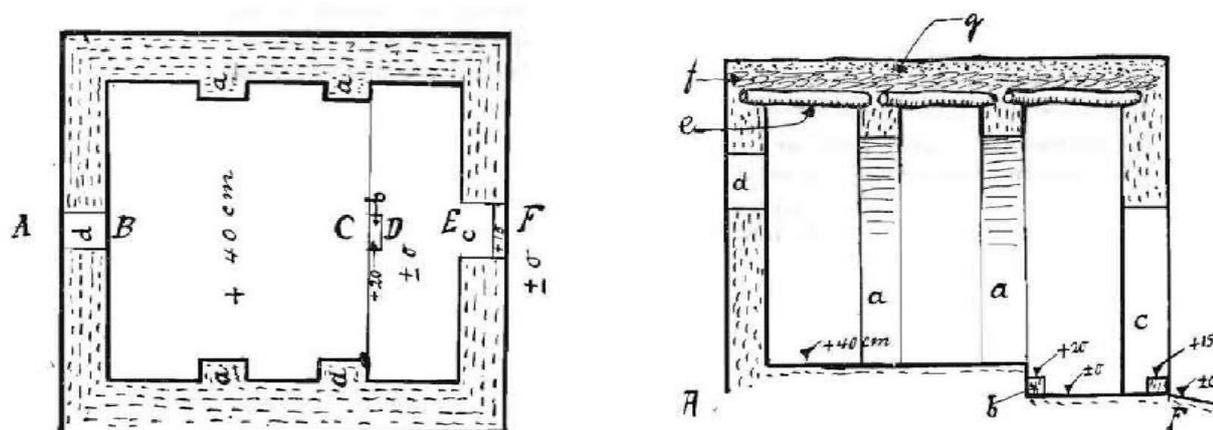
Plan et coupe d'une maison du village de Qbab caractérisée par sa compacité et sa toiture plate en terre battue. (Canaan, 1933).
